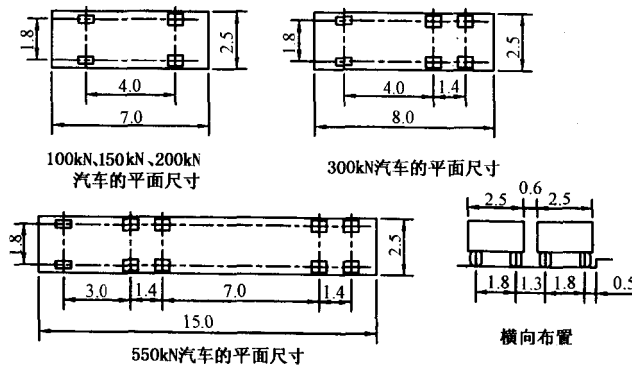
各级汽车的平面尺寸和横向布置 (尺寸单位 :m)
